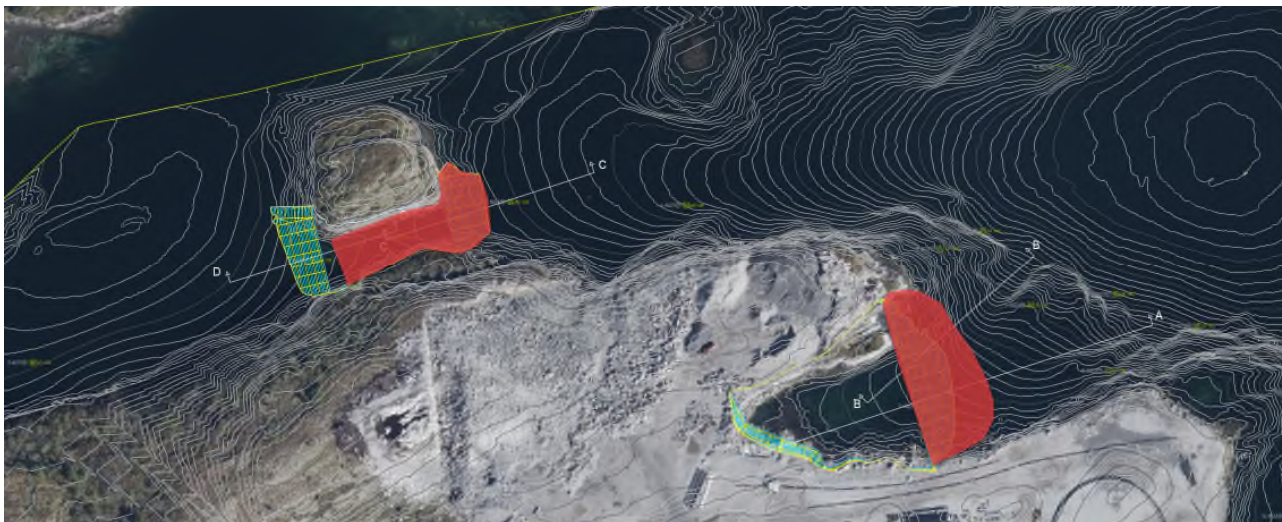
Utsnitt fra planskisse over planlagt utfyllingsareal.
